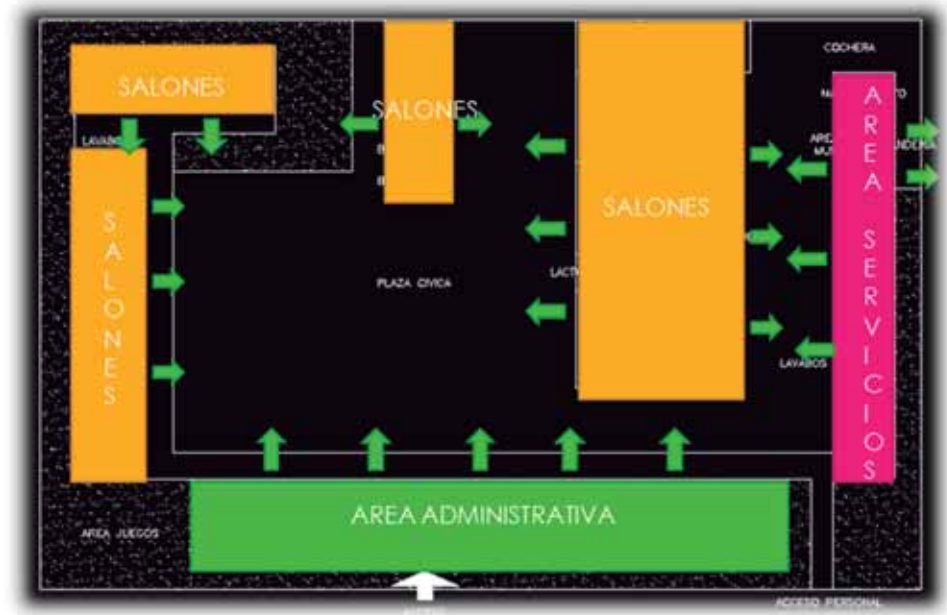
Croquis de la planta de conjunto del CENDI SEP N° 8. Señalando las zonas con las que cuenta
